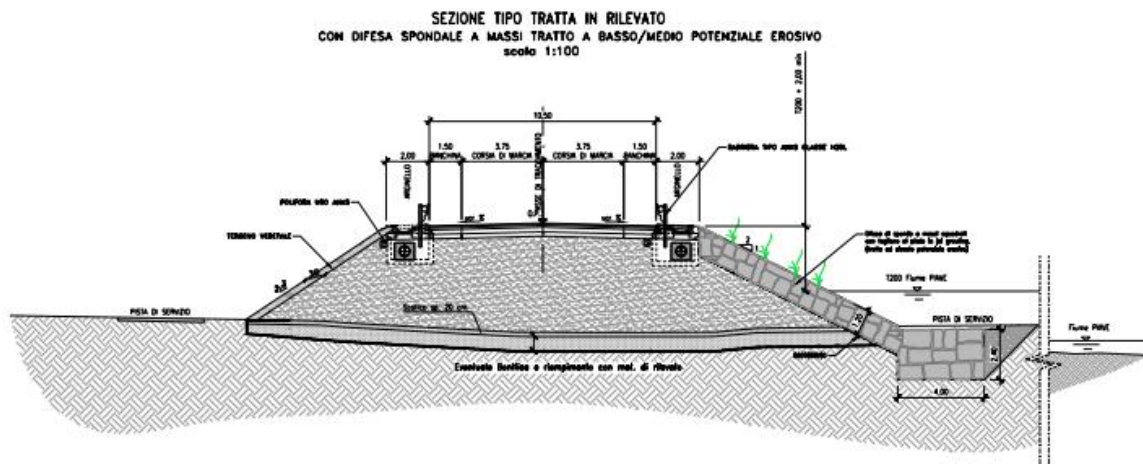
Sezione con protezione di sponda e piede con massi ciclopici.
